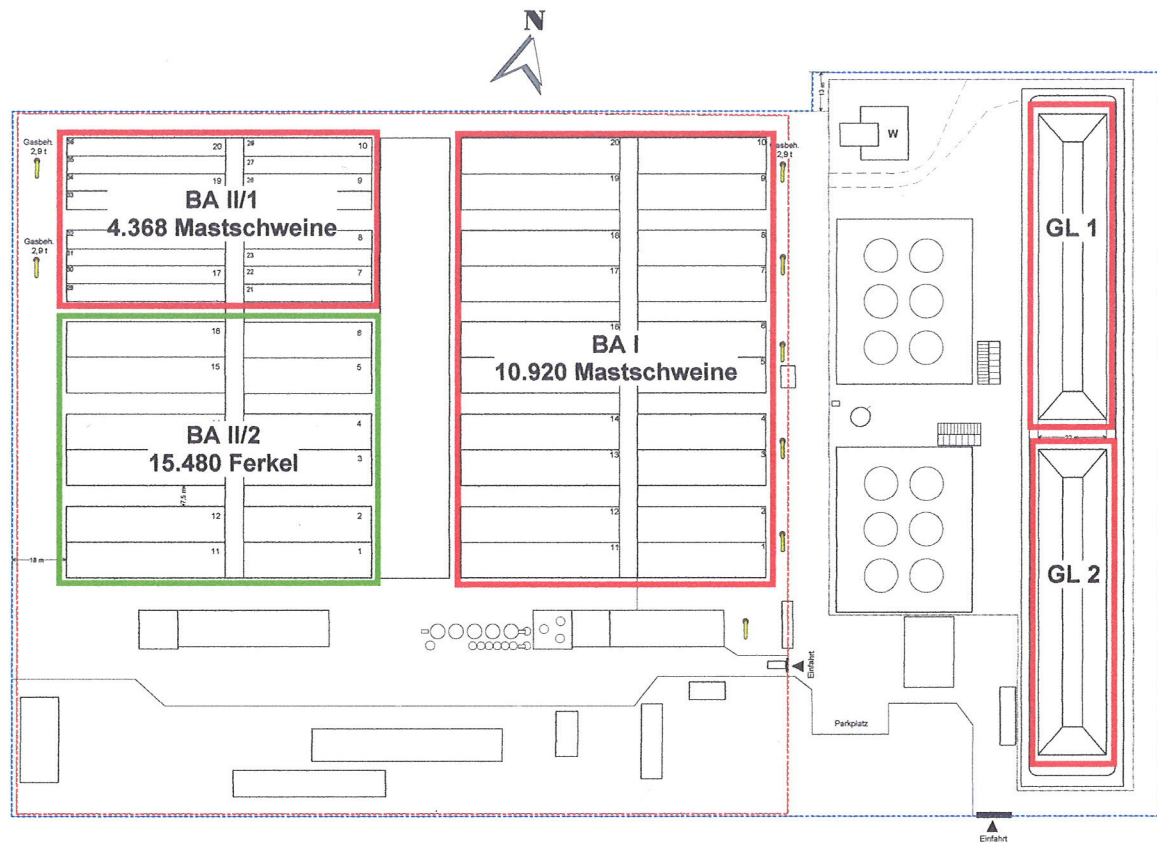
Übersichtsplan der Stallanlage (Plan-Zustand)
